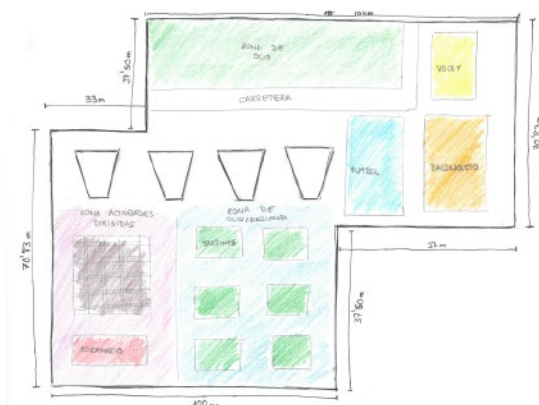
Boceto 1 de la planta de la Plaza de las Ingenierías y alrededores
